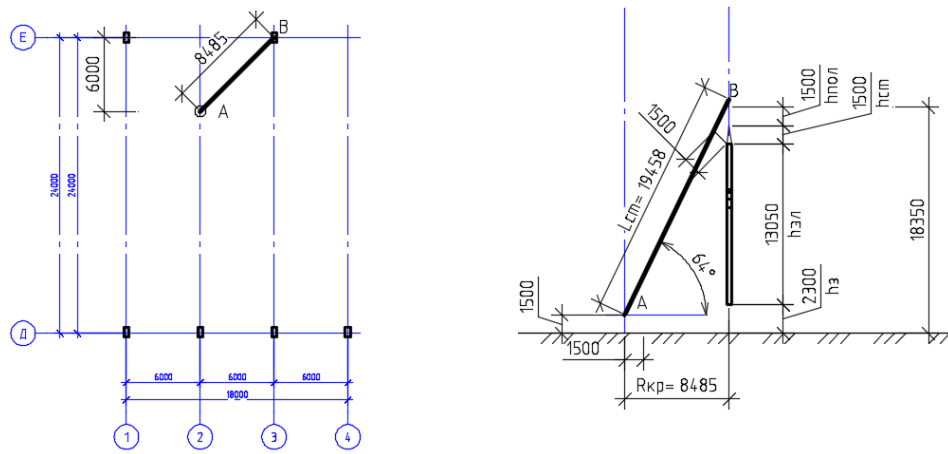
Схема выбора стрелового крана для монтажа колонны
